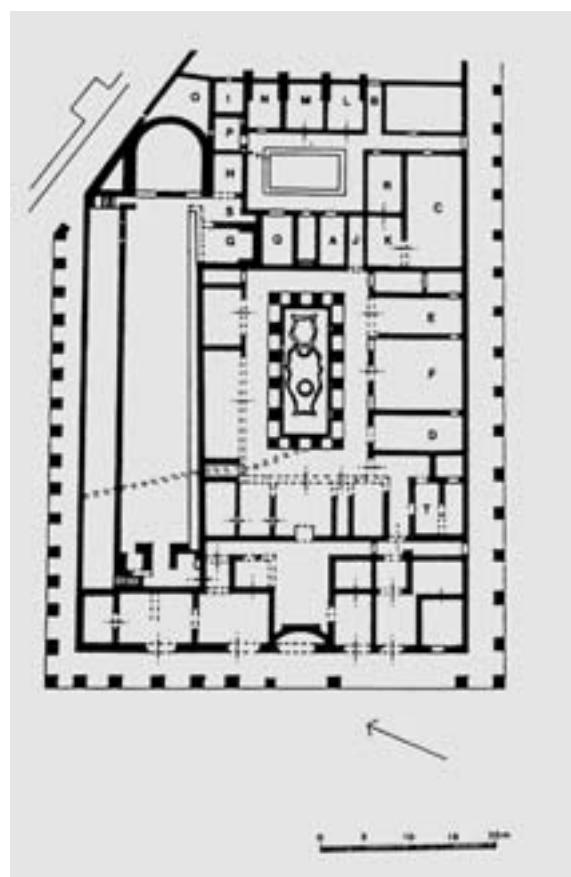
Itálica, casa de la Exedra (ROLDÁN, 1991: fig. 1, sobre planta de García y Bellido).
